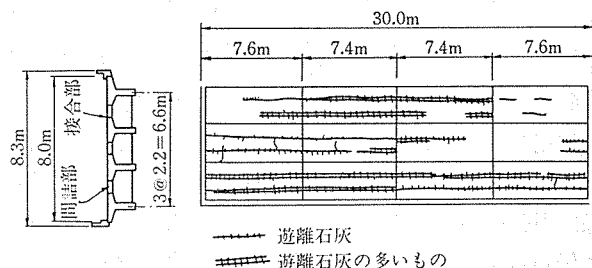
床版下面のひびわれ状況(0.2 mm 以上)
